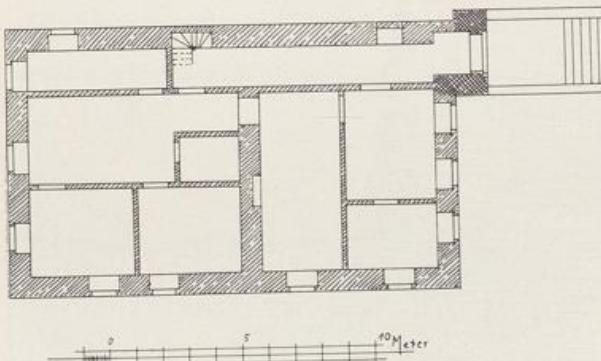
Juntersdorf. Grundriss des Herrenhauses der Burg.
